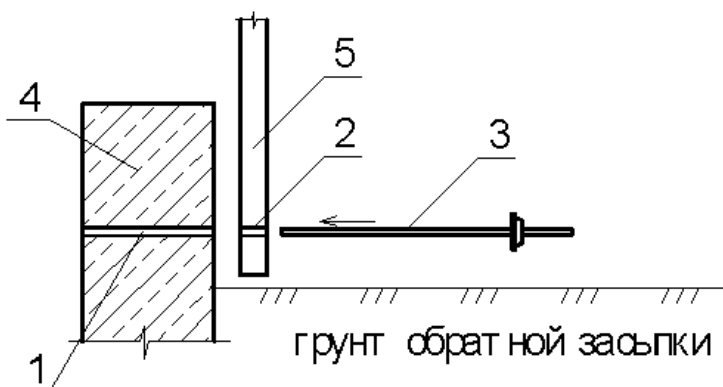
Ориентация щита стеновой опалубки на месте установки. 1 – верхнее отверстие в стене, 2 – нижнее отверстие в щите, 3 – стяжной болт, 4 – подпорная стена, 5 – щит опалубки.
